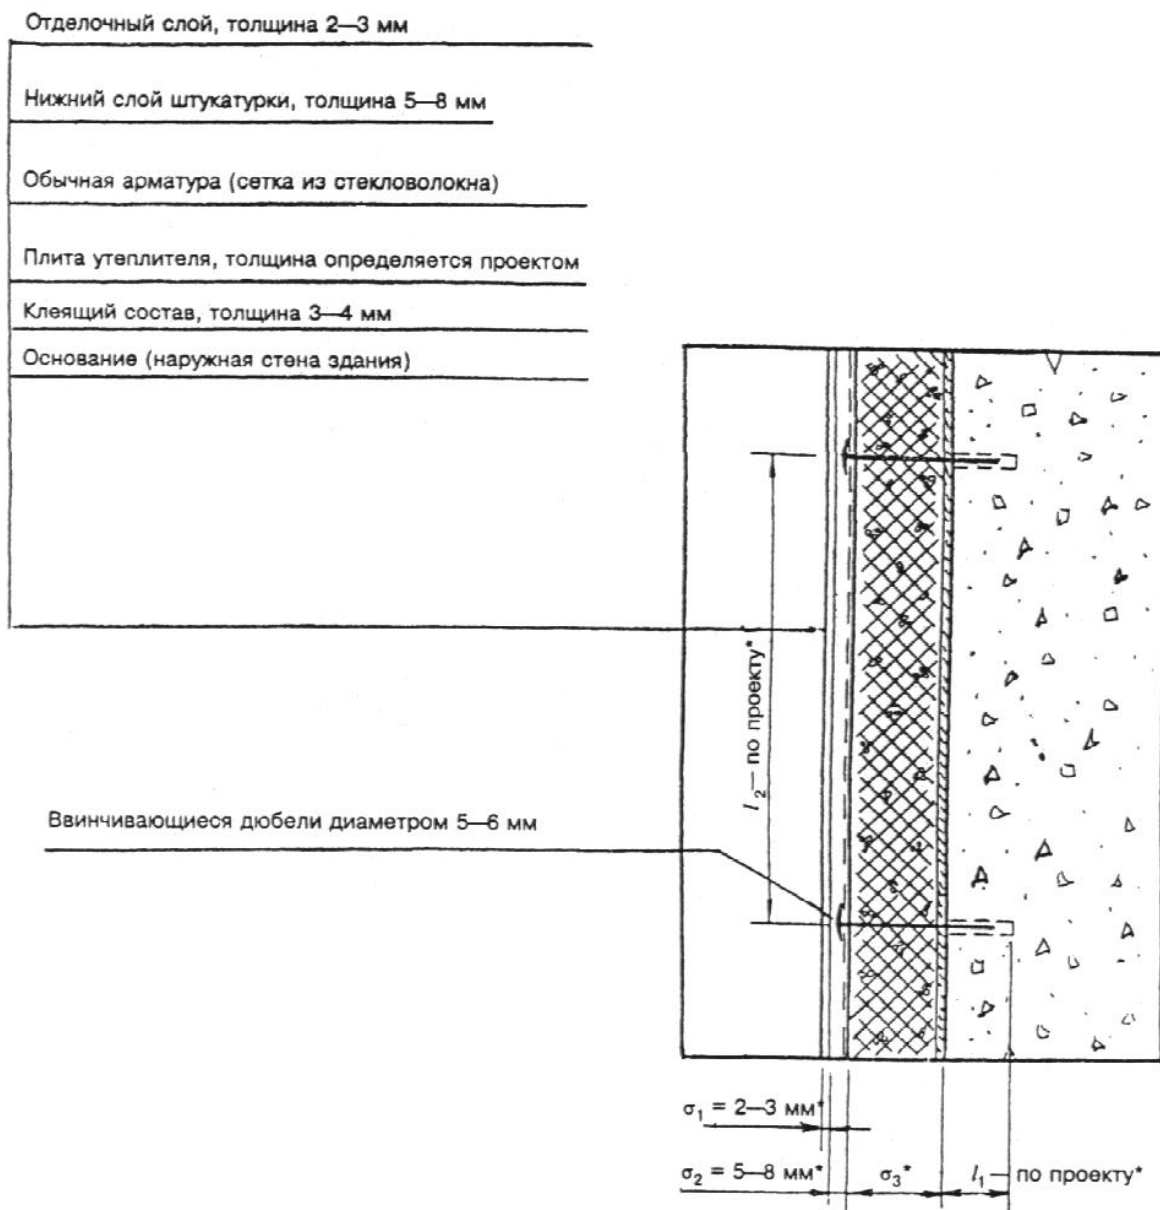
Фрагмент наружной теплоизоляции здания с тонкой штукатуркой по утеплителю
